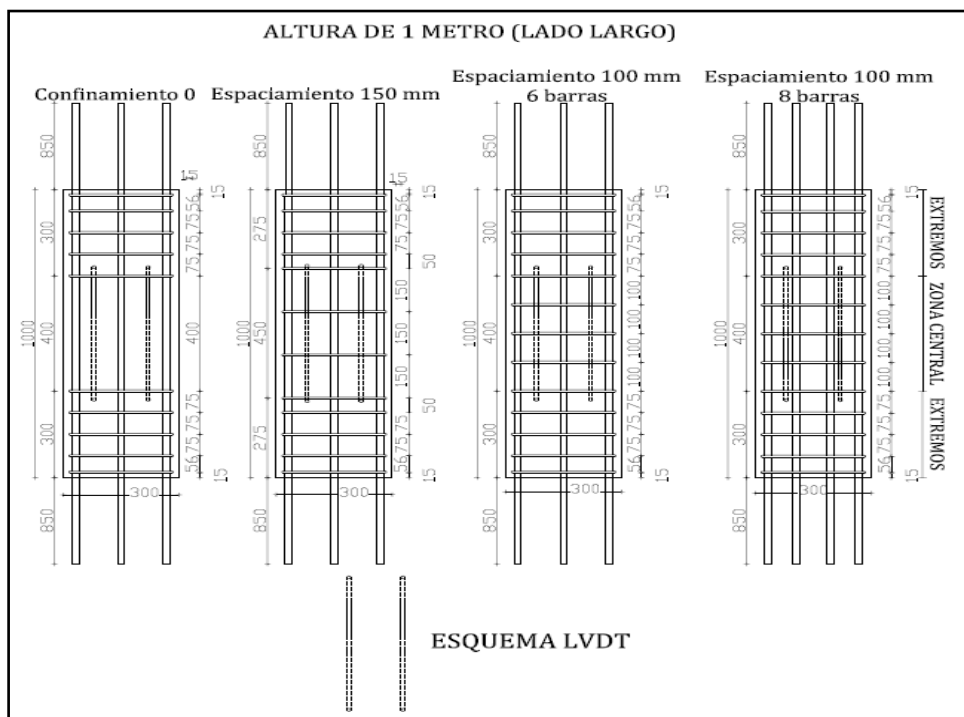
Distribución armadura transversal probetas con pre tracción de 1 m (barras pasadas)
